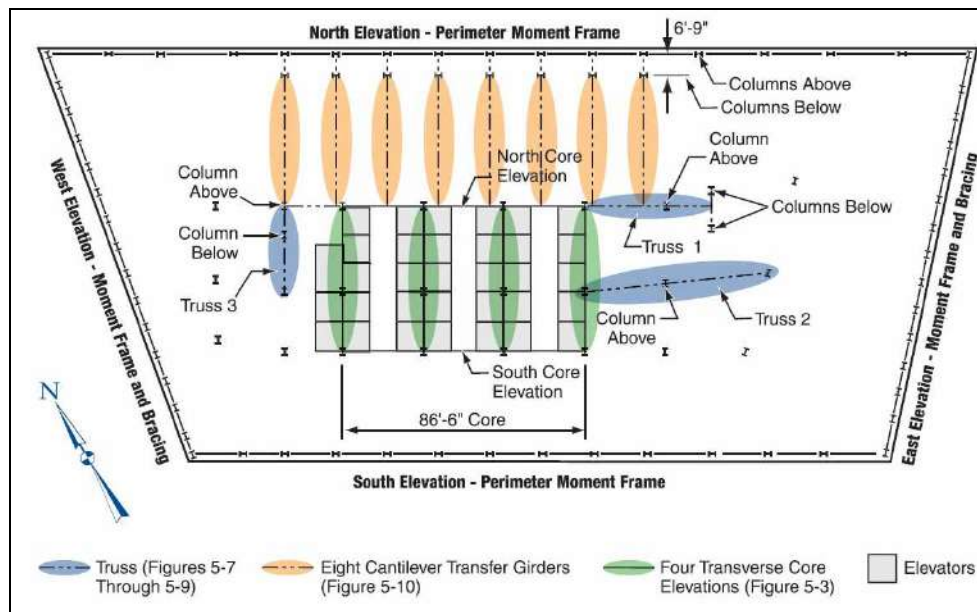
pianta dell'impalcato al 7° piano in cui sono visibili le travature e le travi di trasferimento dei carichi.
